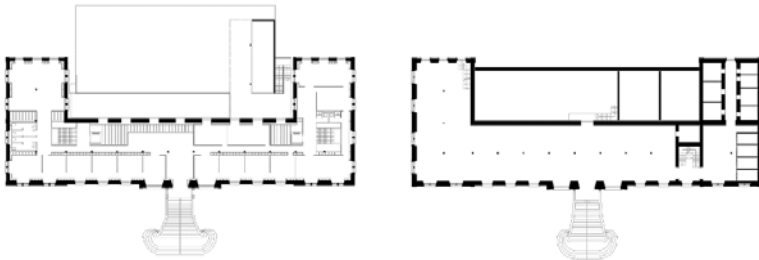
Planta primera. Edificio Reutilizado/Edificio Original.
